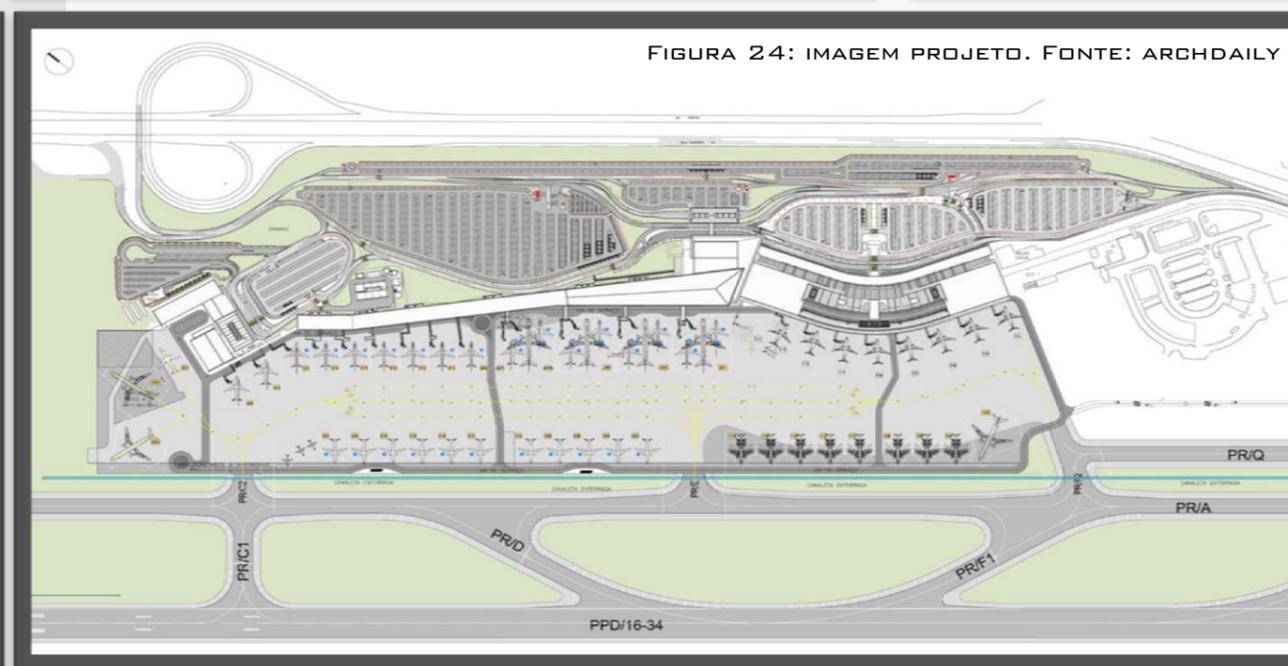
IMAGEM PROJETO. FONTE: ARCHDAILY
